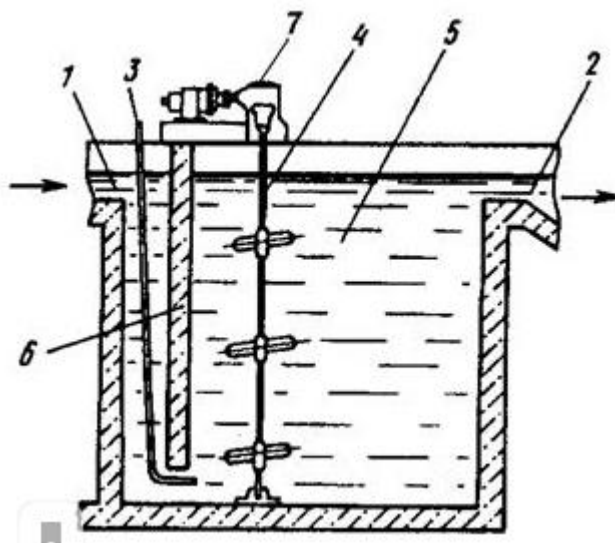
Механический смеситель с мешалкой пропеллерного типа
